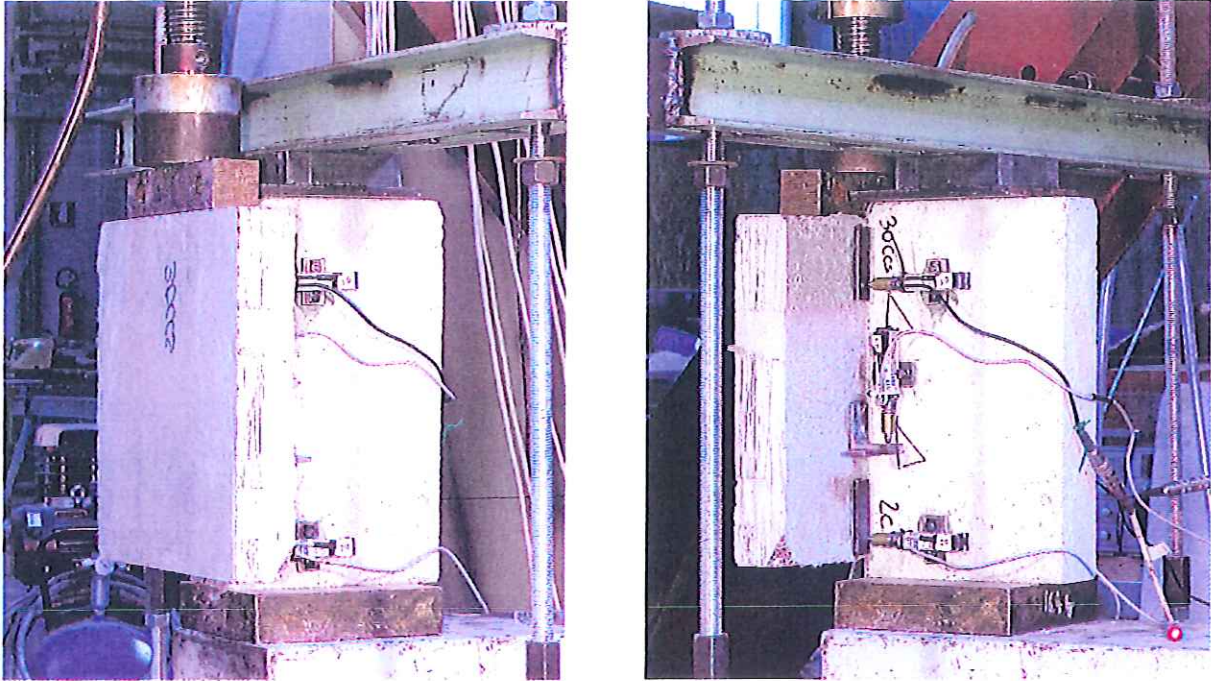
CS Concrete campione 29 - aspetto della giunzione al termine della prova.-
